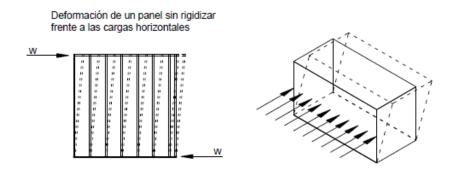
Diagrama de esfuerzos horizontales sobre paneles Steel Frame. Fuente: (ConsulSteel, 2014).
